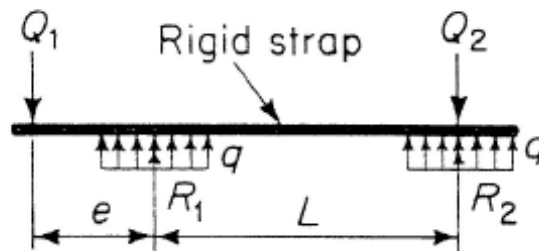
Modelo análisis Zapata aislada con viga centradora. Teng [10].
